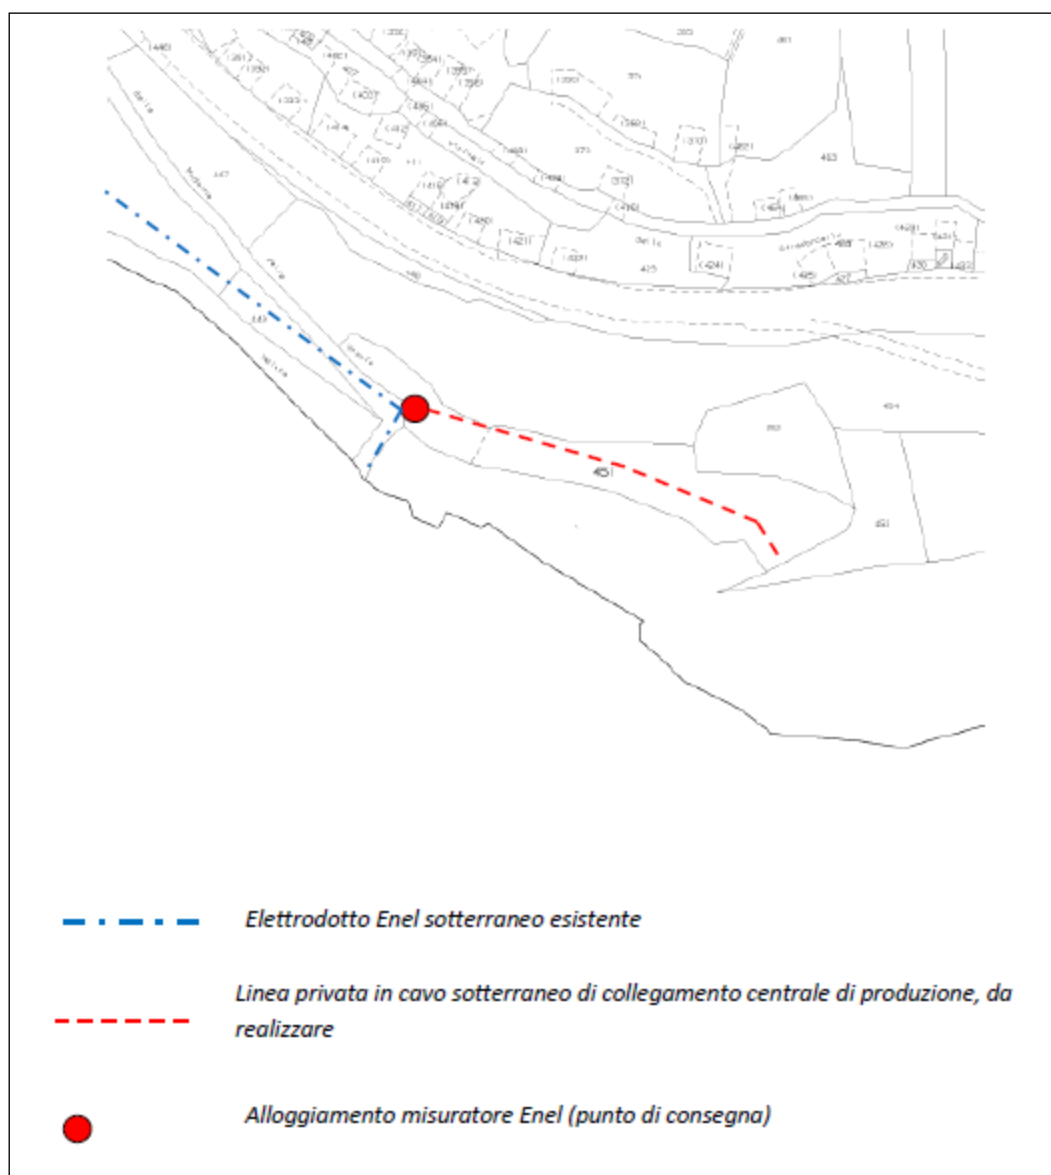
Planimetria con le opere di E-Distribuzione e le opere private
